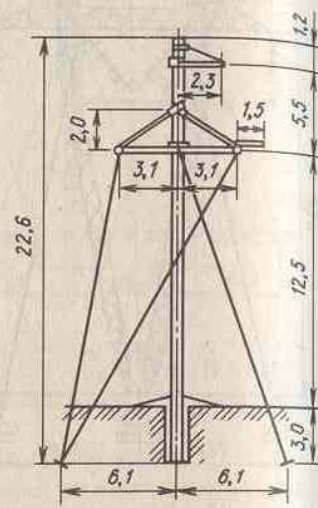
Железобетонная анкерная угловая одноцепная опора на растяжках ВЛ 110 кВ
